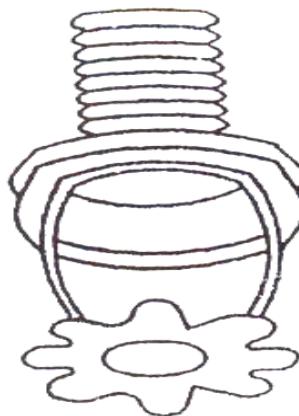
2. 4 Sprinkler Head Tipe Side Wall
